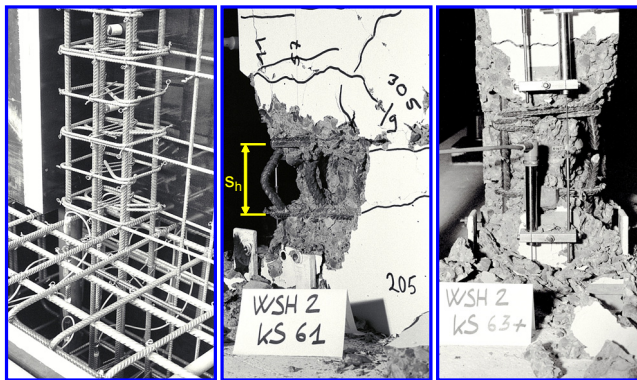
Ungenügende Anordnung der Stabilisierungsbewehrung im plastischen Bereich einer Stahlbetontragwand
